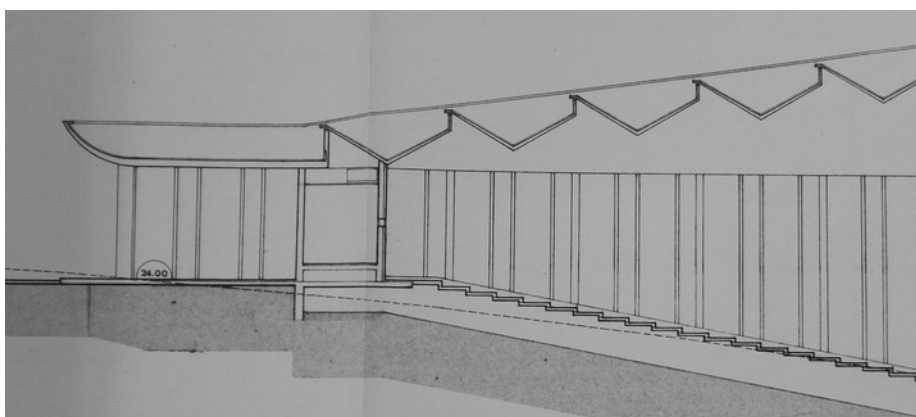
Plan de masse avant-projet, coupe longitudinale. Arretche et Boquien. 30 juin 1957. ADLA1078W50
